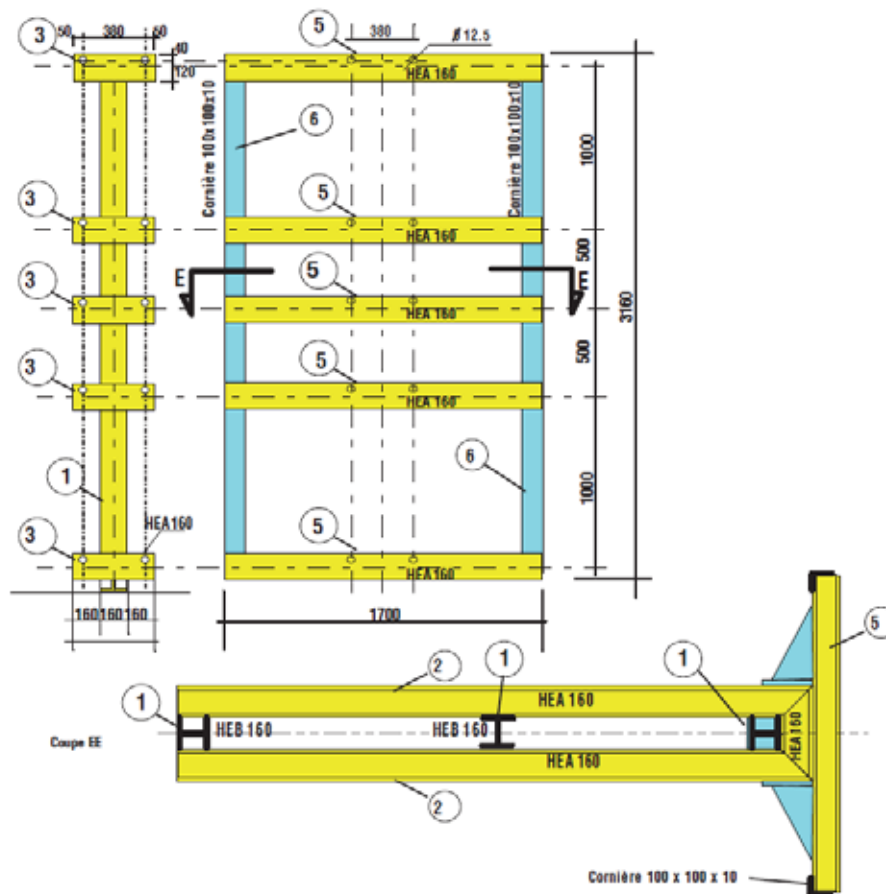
Schéma du dispositif pour les essais dynamiques perpendiculaires au plan du support
